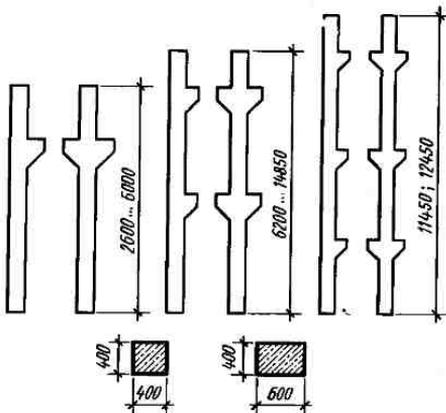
Типы железобетонных колонн многоэтажных промышленных зданий при опирании ригелей на консоли колонн
